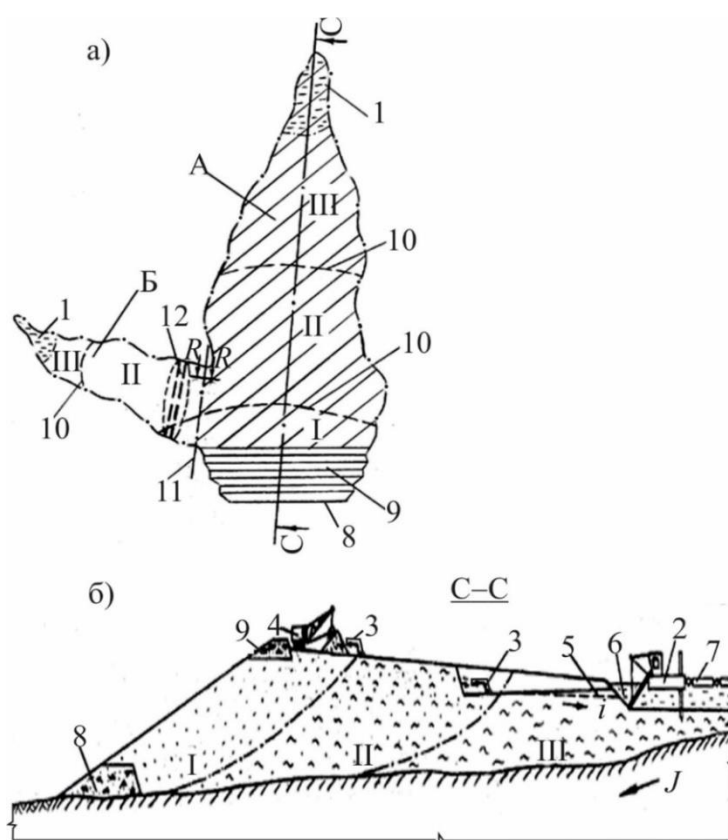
Схема обеспечения безопасного доступа к промышленным запасам угля, которые залегают под гидроотвалом: а) схема переукладки гидроотвала; б) продольный разрез гидроотвала. А – часть гидроотвала, породы которой подлежат отработке;
